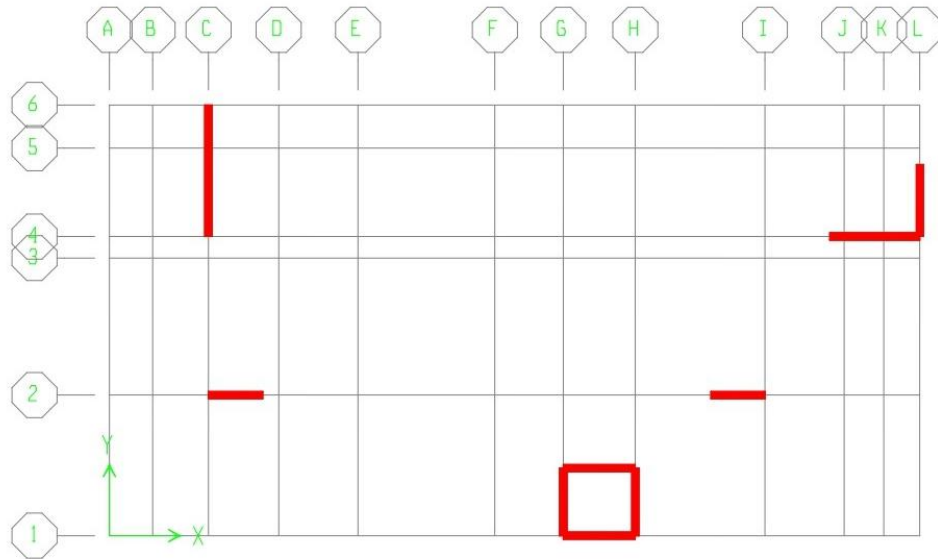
Disposition des voiles de contreventement en plan - proposition architecturale
